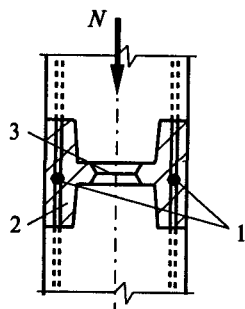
Стык колонн: 1 — ванная сварка; 2 — бетон на мелком щебне; 3 — центрирующие площадки
